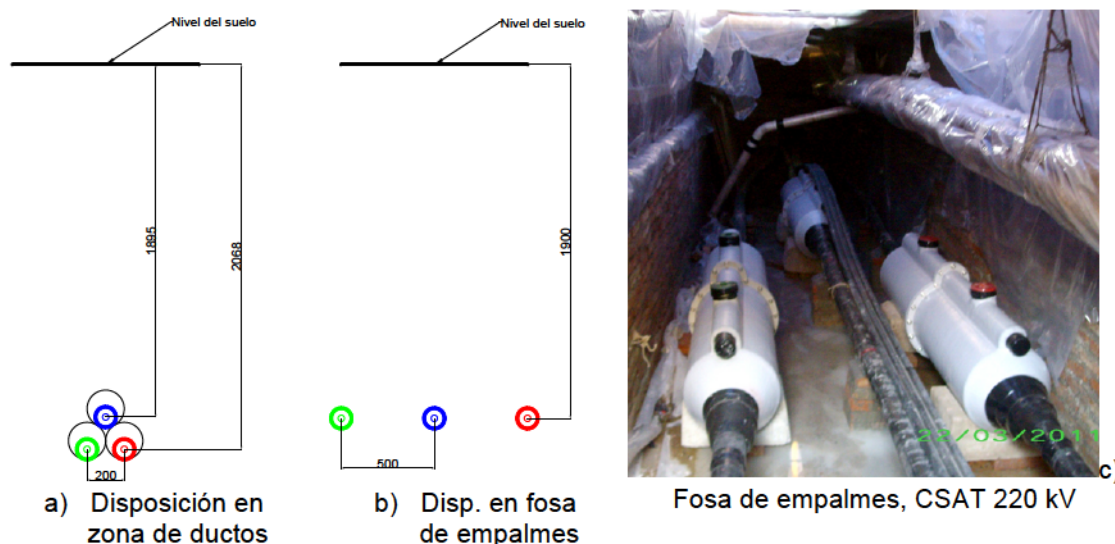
Cortes transversal de un tendido de cables e imagen de una fosa de empalmes.
